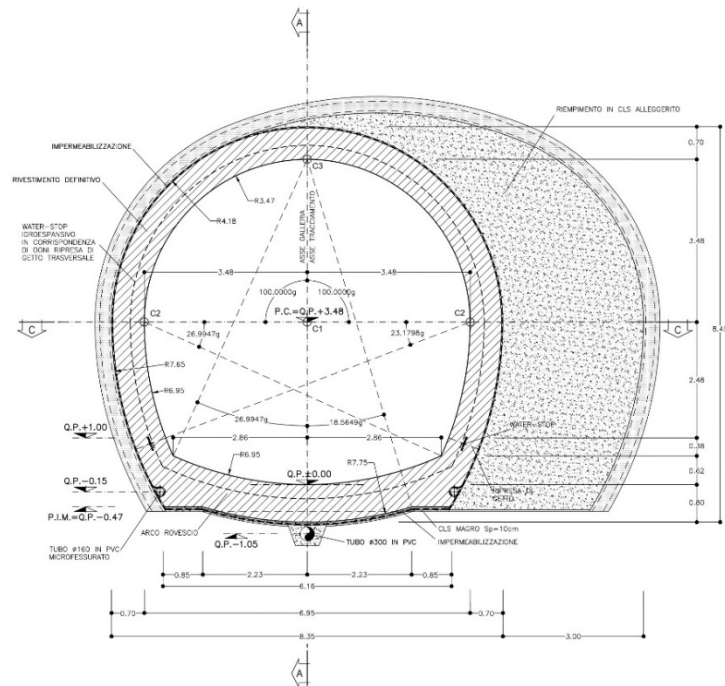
Sezione Tipo B2 “Allargata” – Carpenteria – Sezioni
